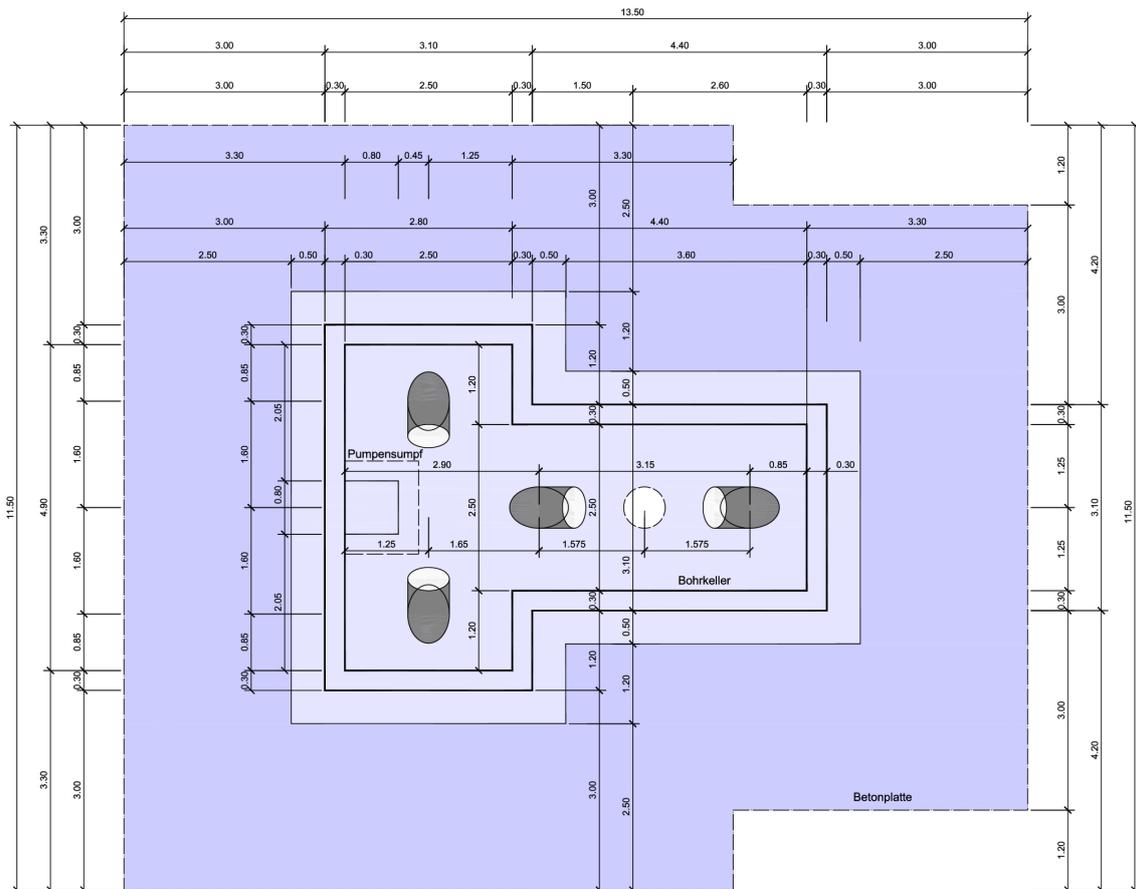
Grundriss des Bohrkellers für fünf Bohrrichtungen.
